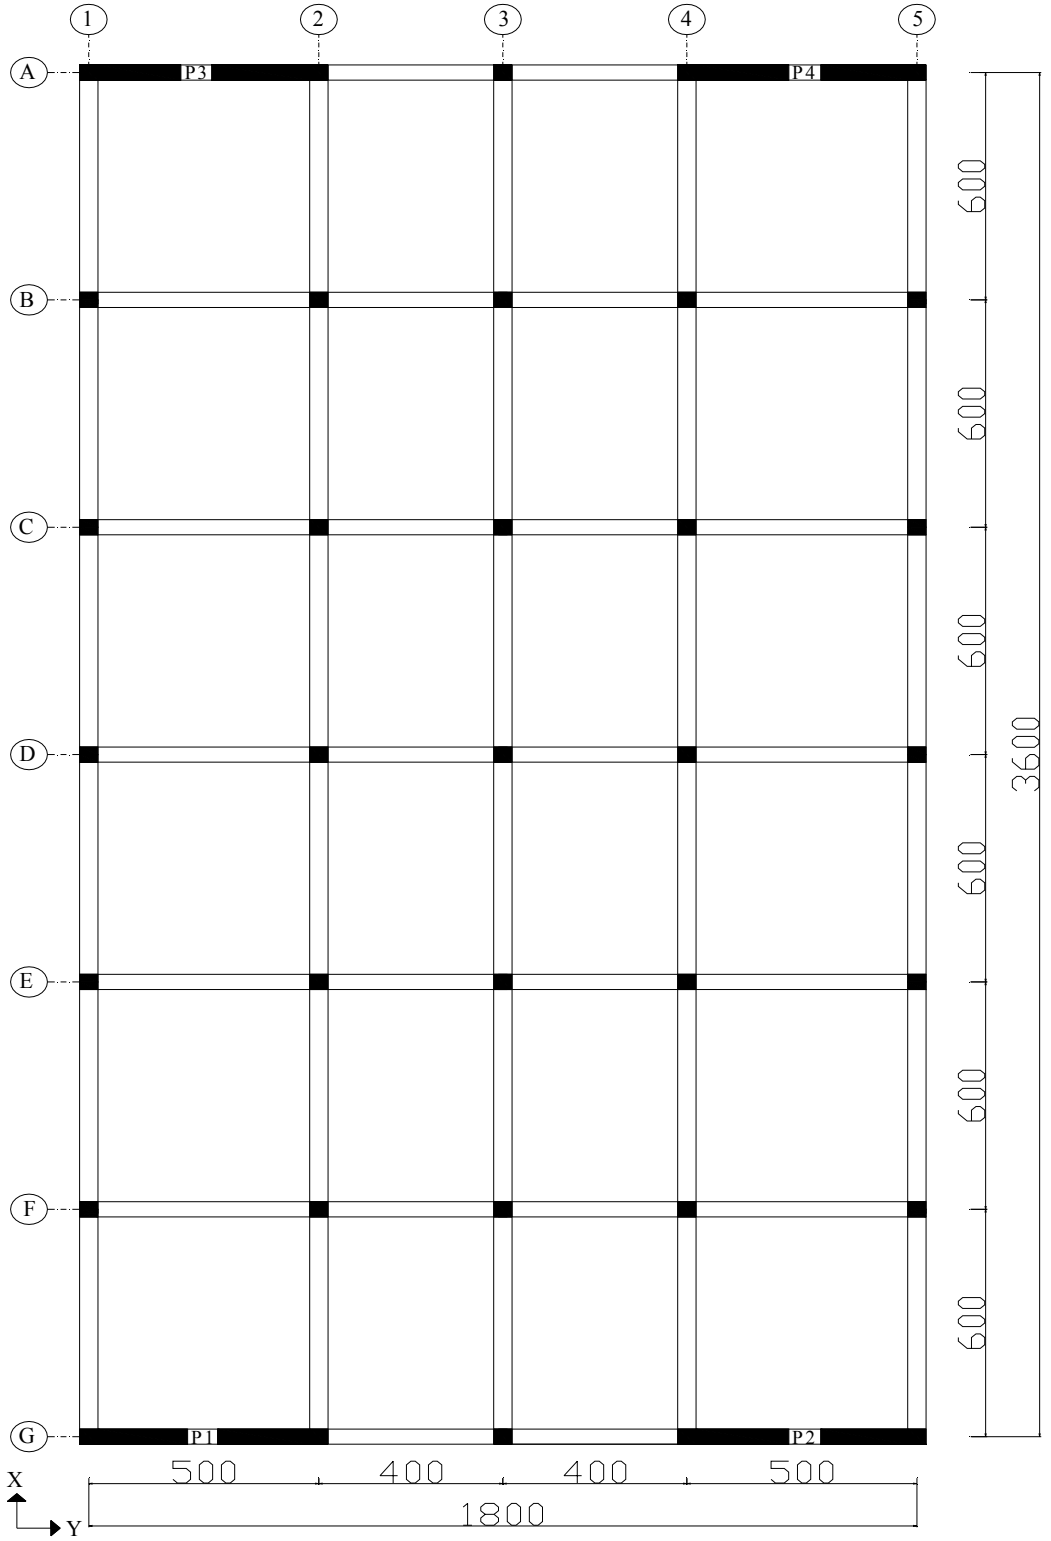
Örnek 5.5'in kat kalıp planı
